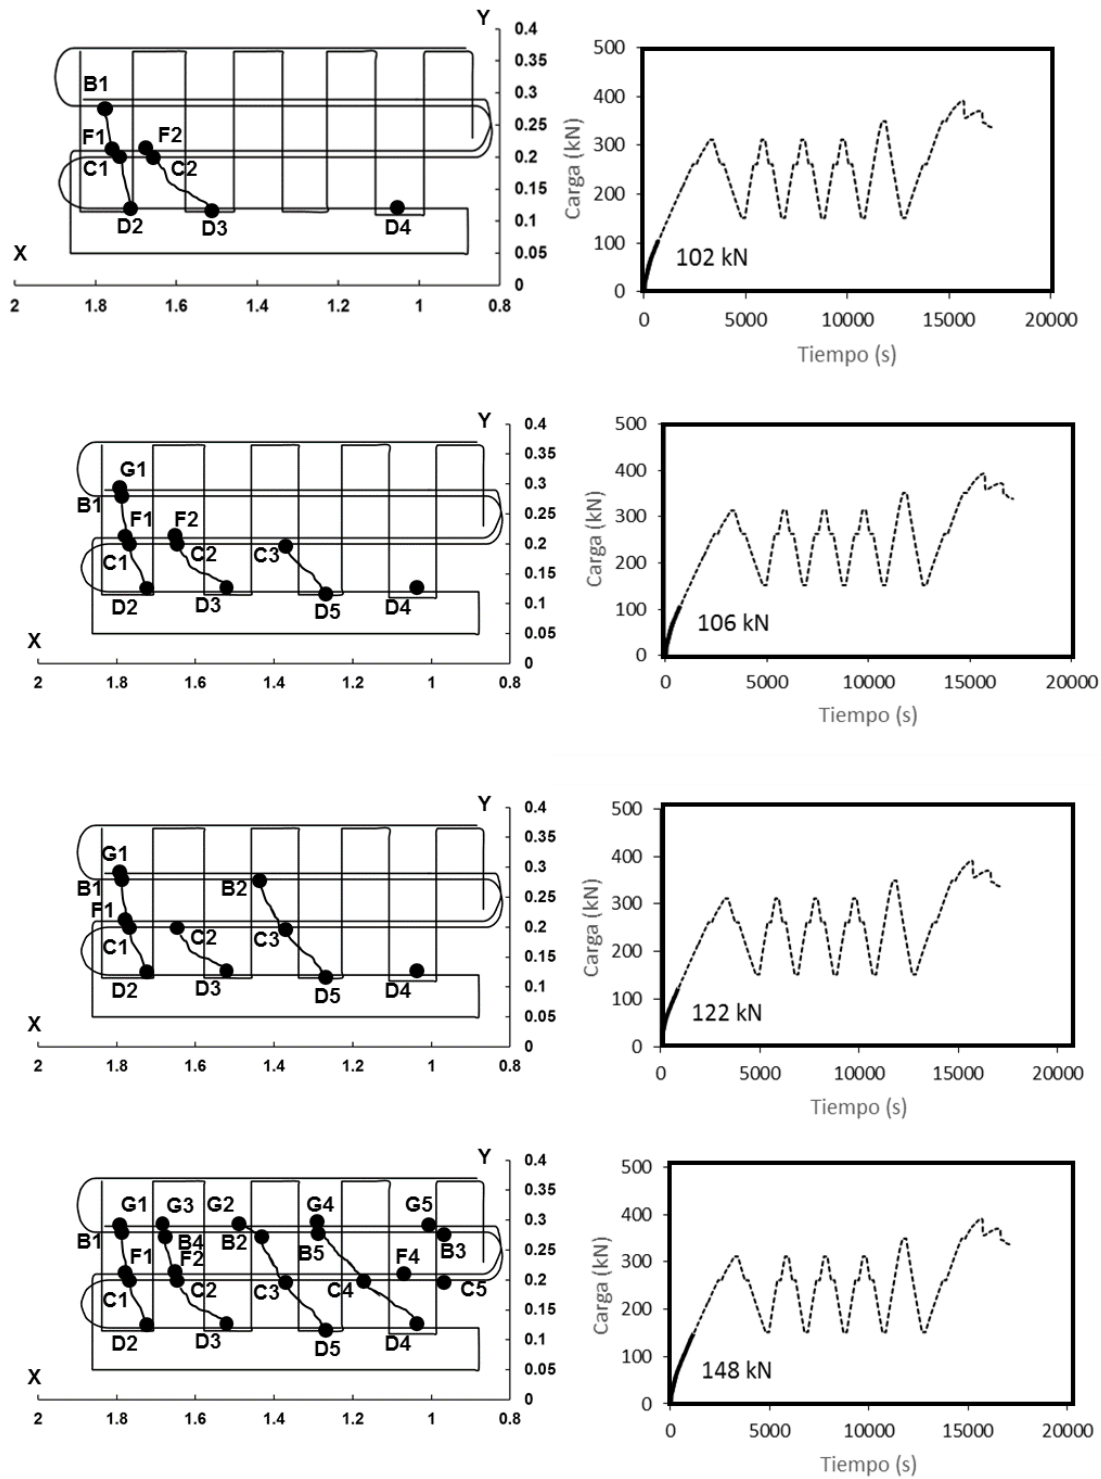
Patrones de fisuración de la viga I-1 (102 a 148 kN)
